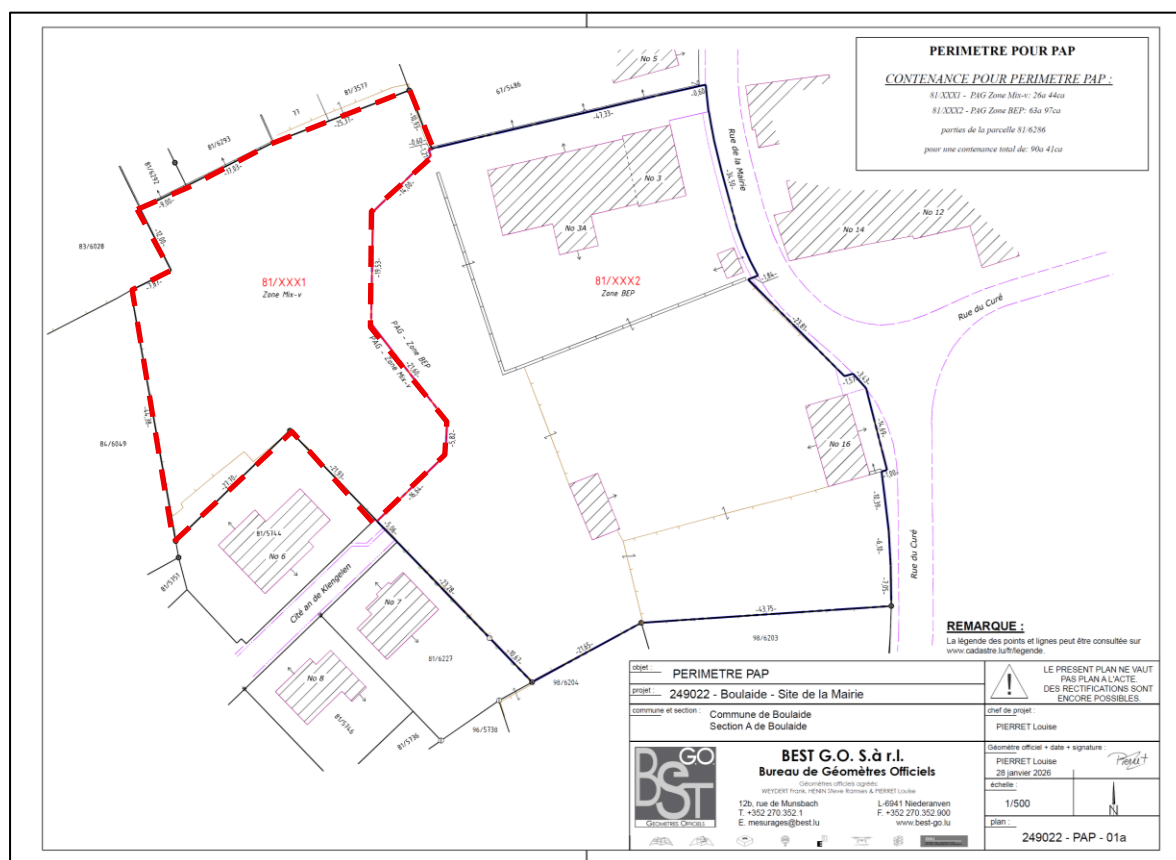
Auszug des „Plan de Surface PAP“ mit Abgrenzung des Plangebiets (rot gestrichelte Linie) (o.M., genordet);
